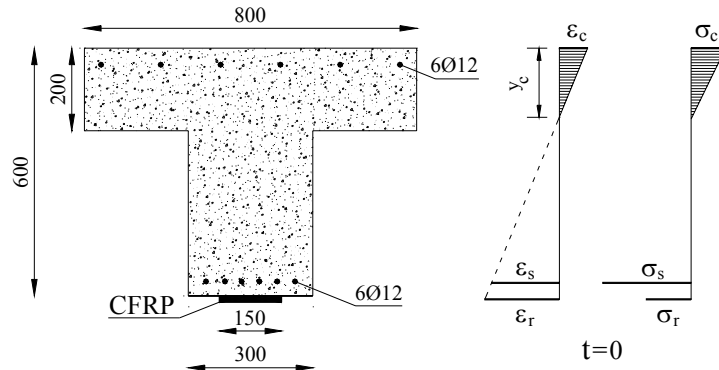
Sezione retta della trave placcata con CFRP (dimensioni in mm)
